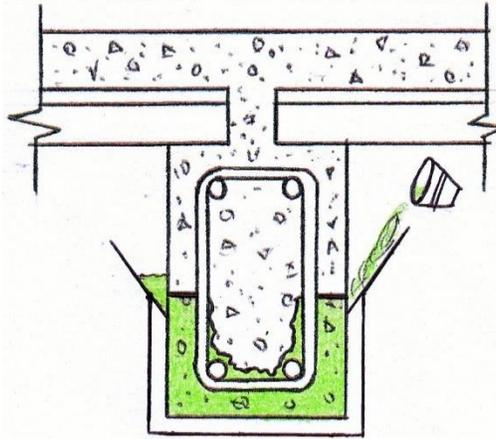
Escarificación del hormigón mediante el corte de área delimitada
